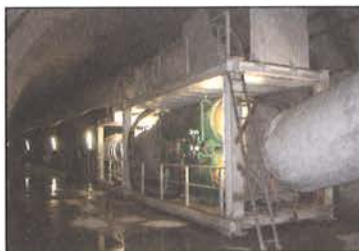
Einer der beiden Zuluftventilatoren im Fusspunkt Ferden im Tunnel West
